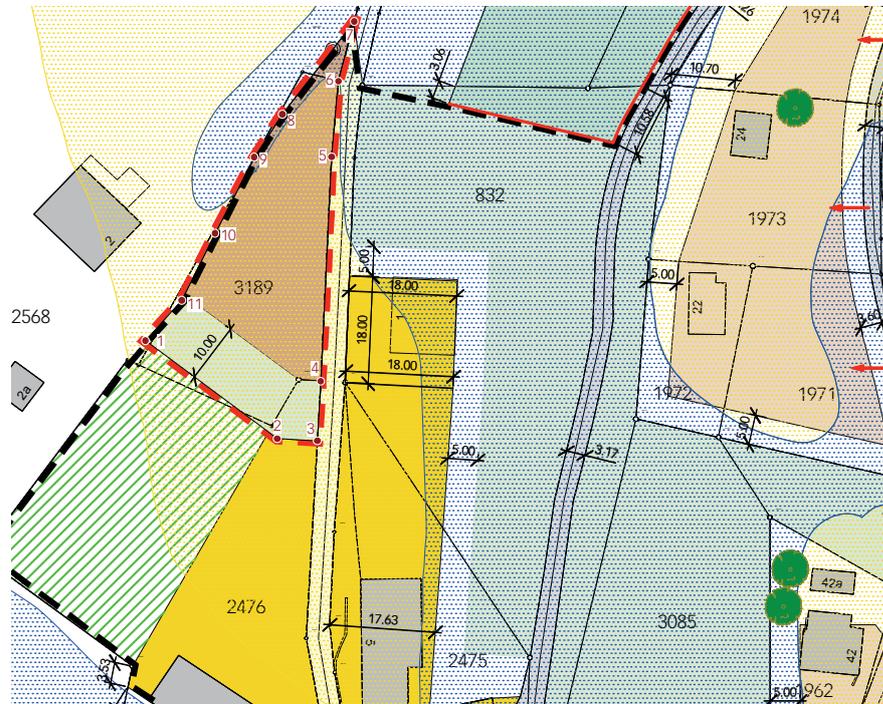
Ausschnitt aus dem geltenden Überbauungsplan.
